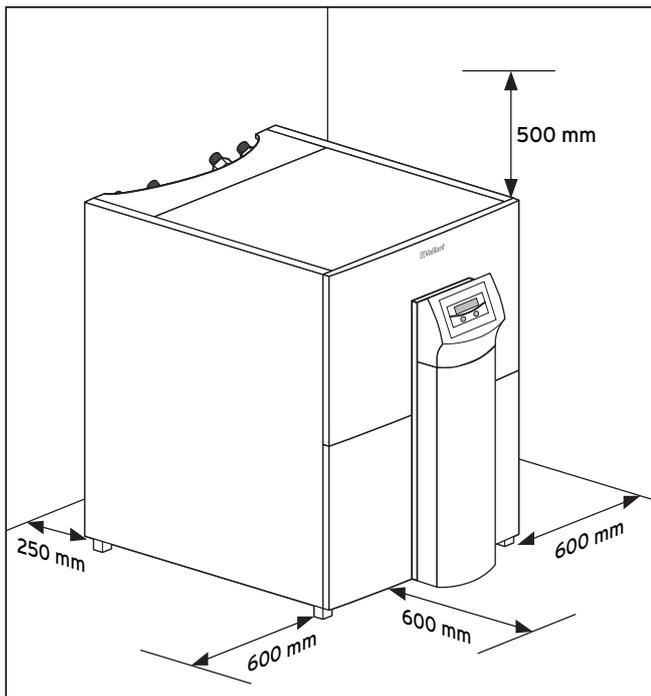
Mindestabstände zur Aufstellung der Wärmepumpe
